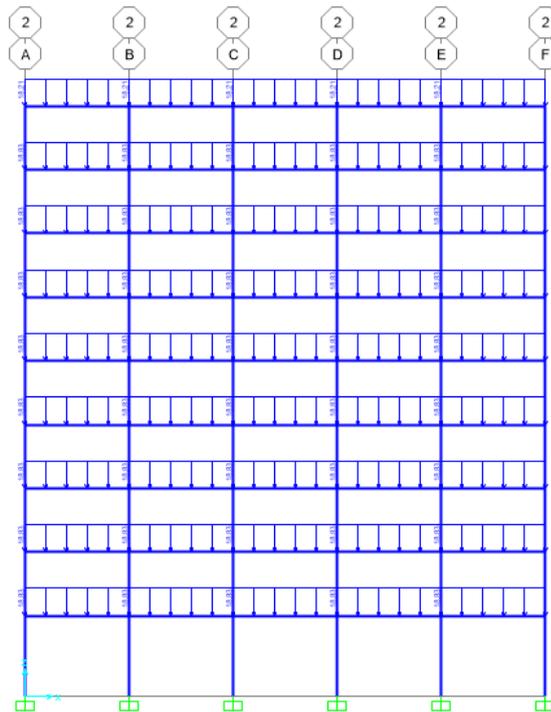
Permodelan Struktur Dengan Dinding Geser
